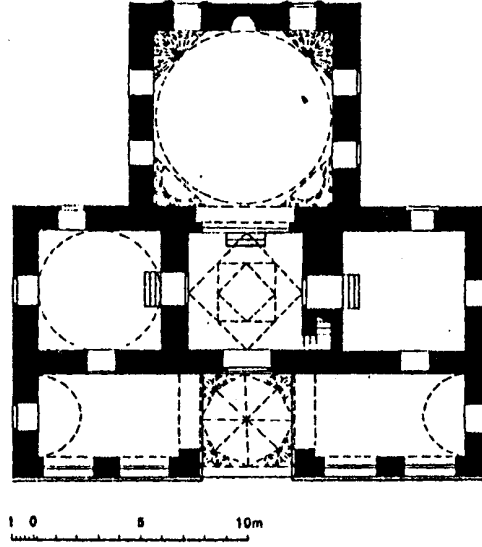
مسقط أفقي لجامع حمزة بك في بورصة أوبروسه (عن : Wilde)
